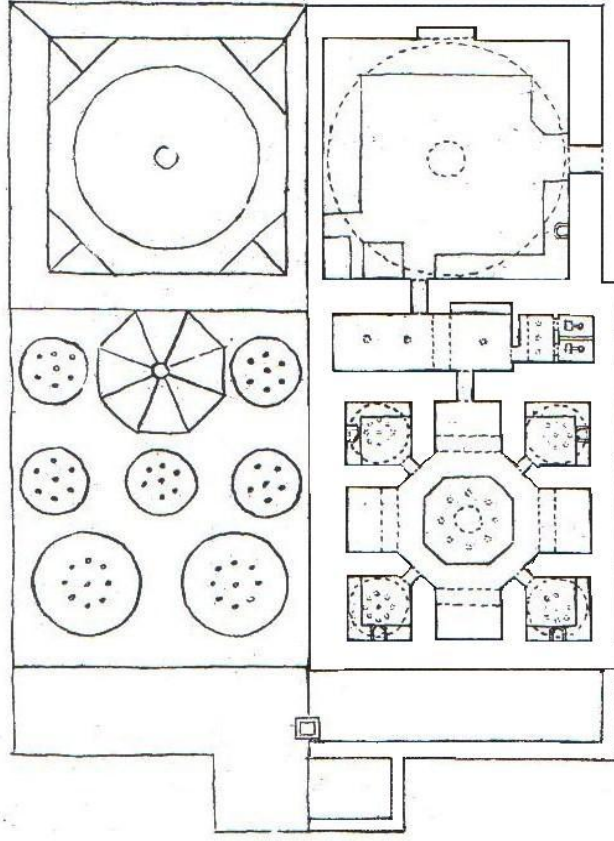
Hayreddin Paşa Hamamı (İstanbul) plan şeması
